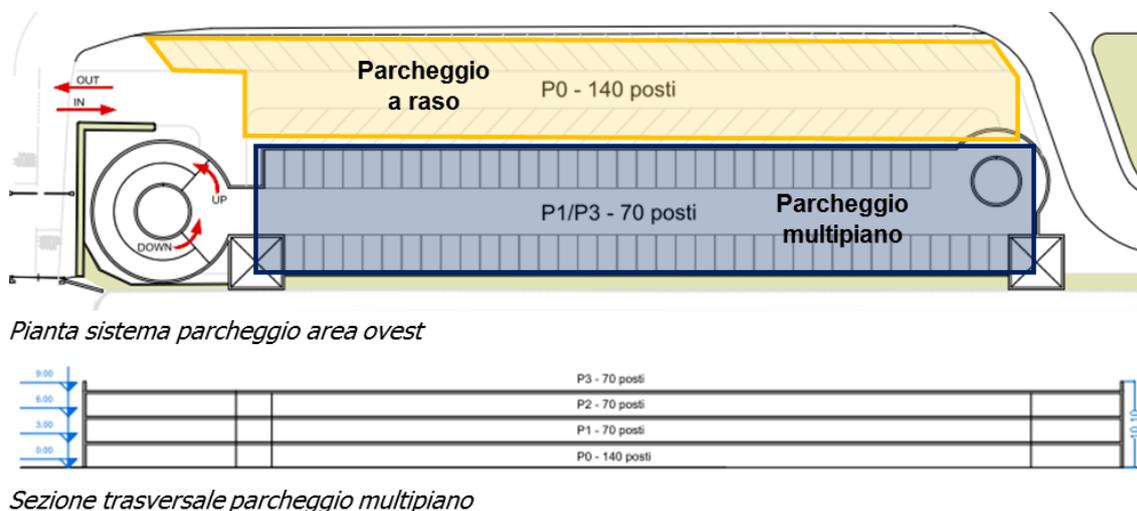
Parcheggi area ovest, pianta e sezione (Fonte: Masterplan, Schede interventi – Scheda 4.5)
